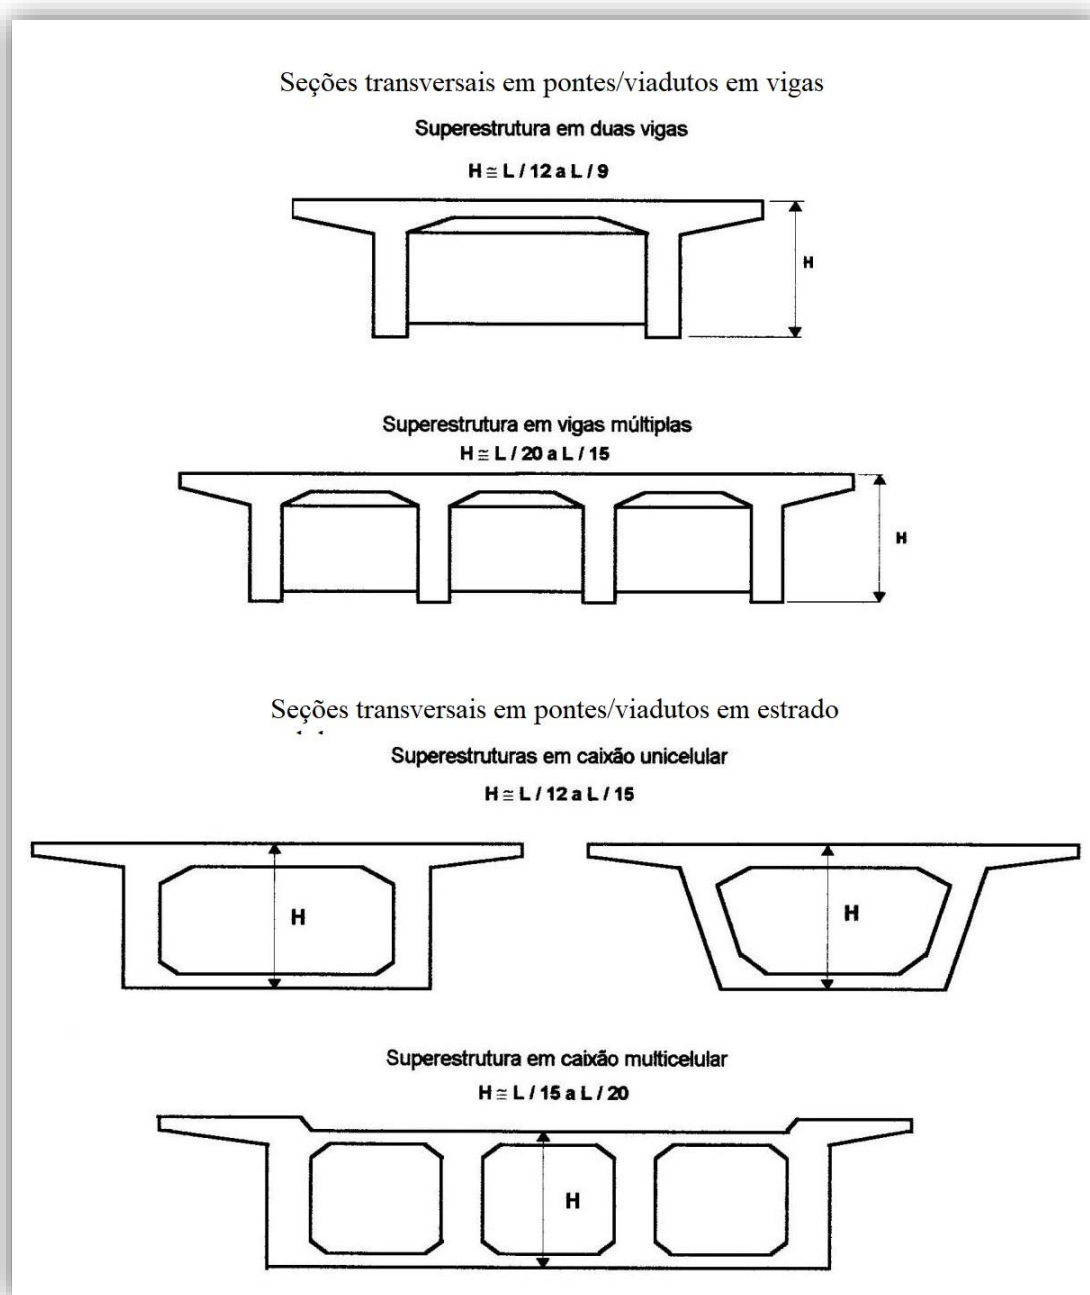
Pré-dimensionamento da altura da viga. Fonte: Lucena, 2018. (Modificado).
